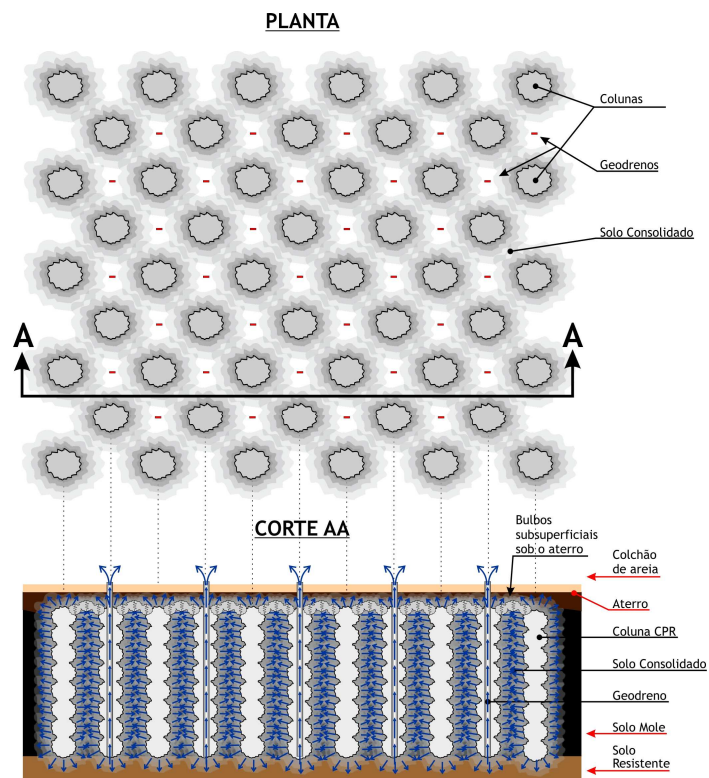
Croqui esquemático da solução de Consolidação Profunda Radial (CPR) - Planta e Perfil (Fonte: ENGEGRAUT, 2009)
